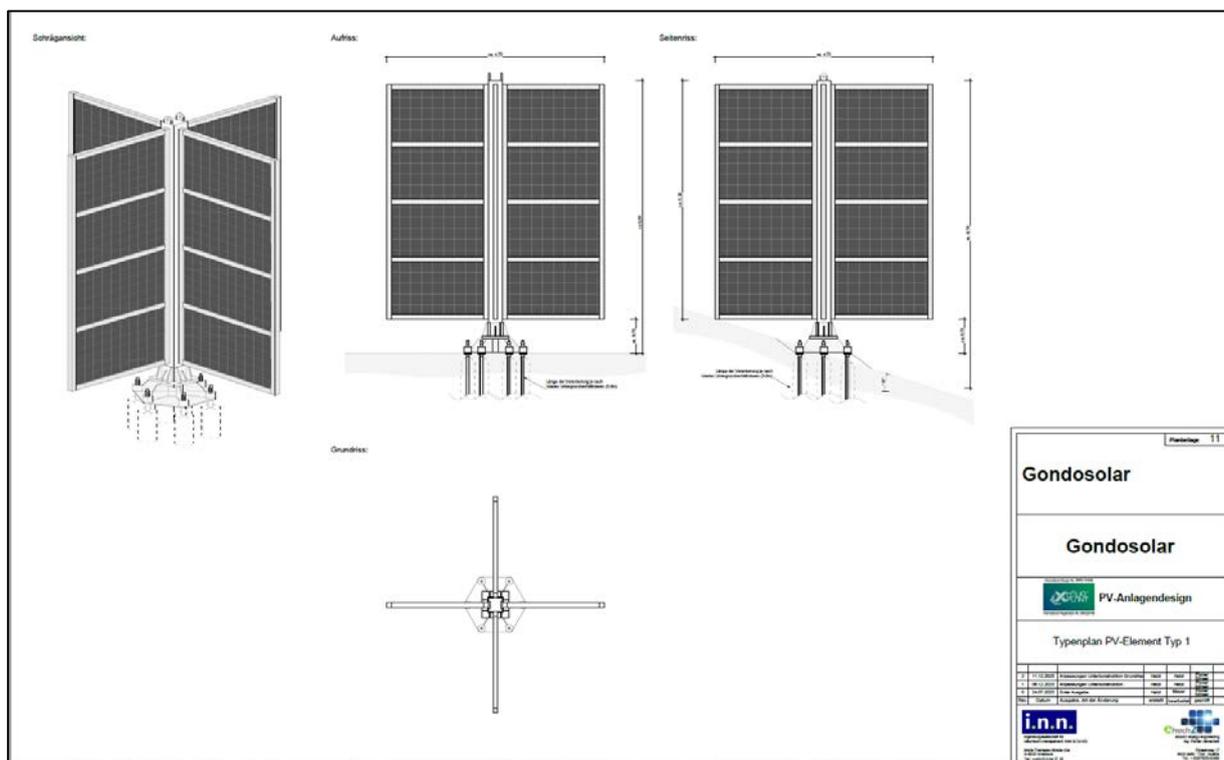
Typenplan HELIOPANT® Typ 1 mit einem Bodenspalt von 0,75m (vgl. Planbeilage 11)
